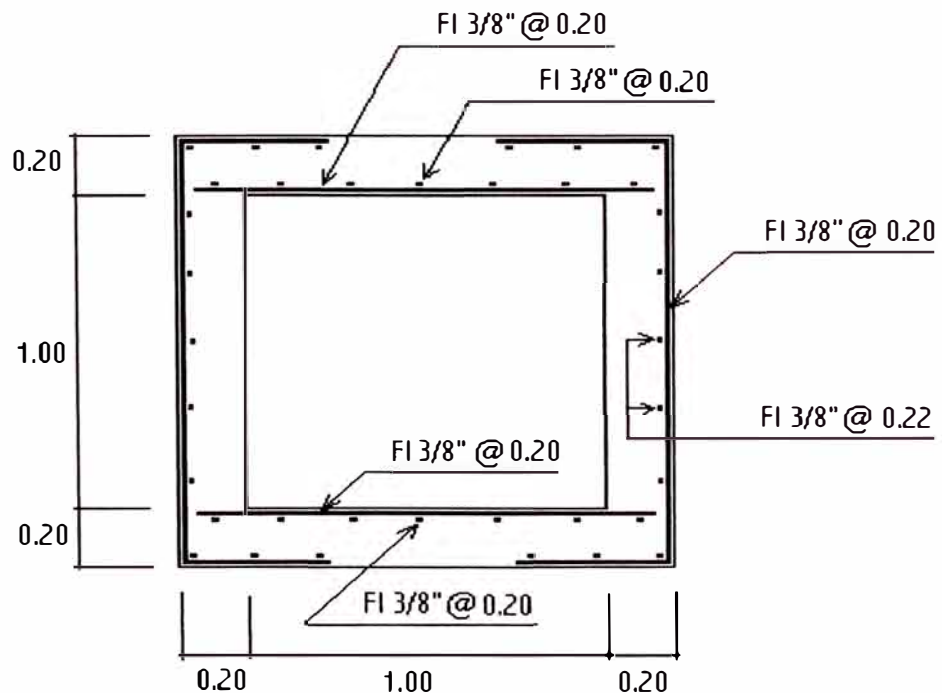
Diagrama Colocación de Acero de Refuerzo.
